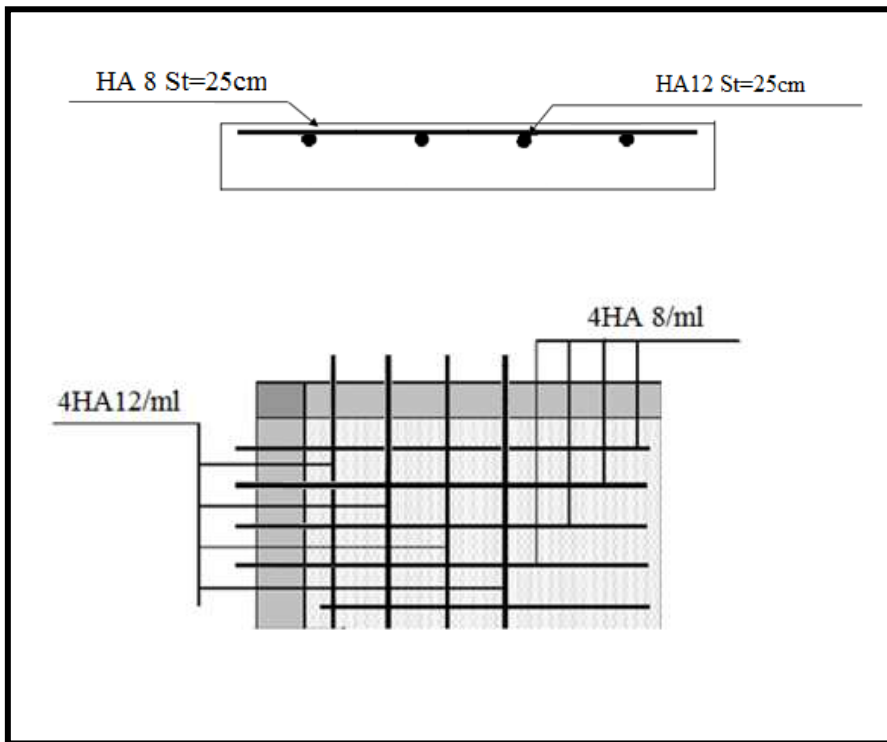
Schéma de ferrailage de la dalle sur deux appuis.
